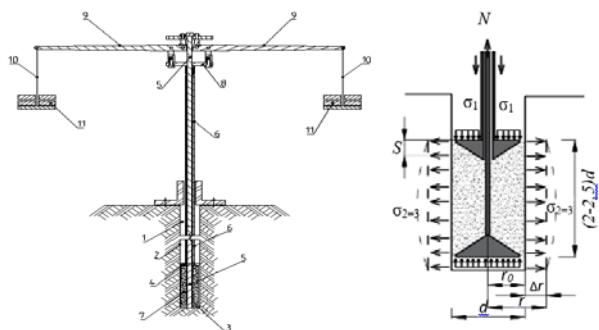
Устройства для определения деформации грунта: 1-скважина; 2-стенка скважины; 3-нижний штамп; 4-верхний штамп; 5-стержень; 6-секция труб (штанга); 7-цилиндр (песок); 8-упорная плита; 9-рычаги с равновеликими плечами; 10-подвеска; 11-гири.
